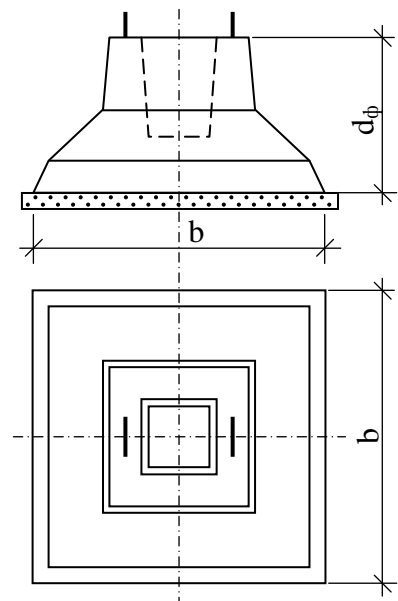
Збірний залізобетонний фундамент за ГОСТ 24476-80
